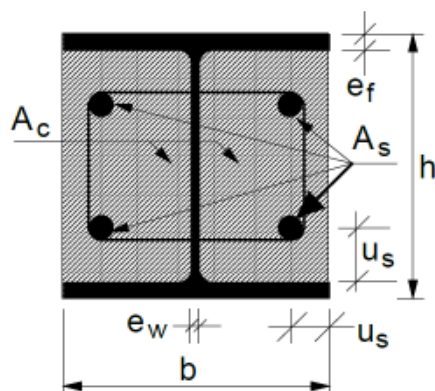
Сталежелезобетонная колонна с частичным обетонированием сечения
